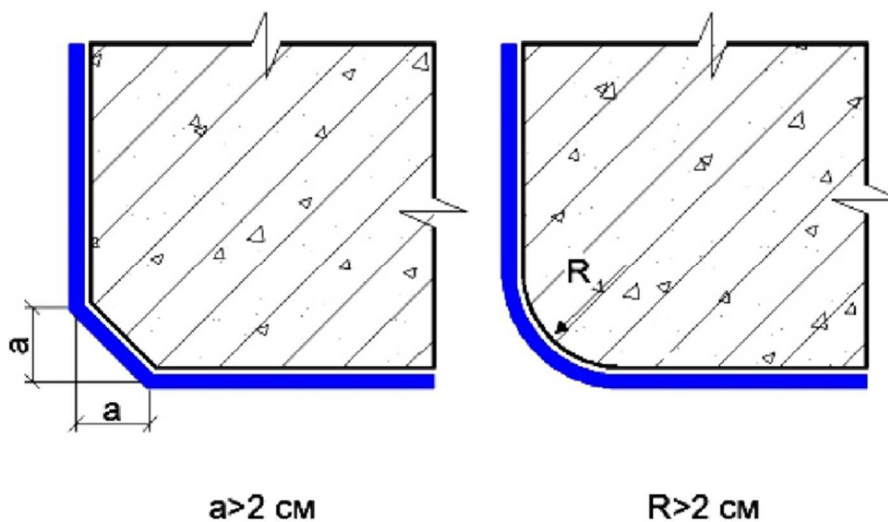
Подготовка углов конструкции перед наклеиванием лент, сеток или тканей
